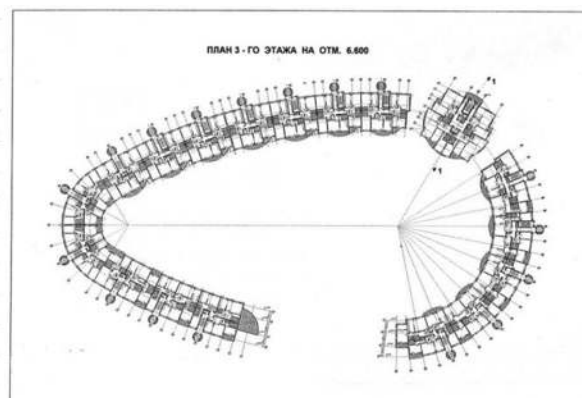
План жилого комплекса на Карамышевской набережной 66.
